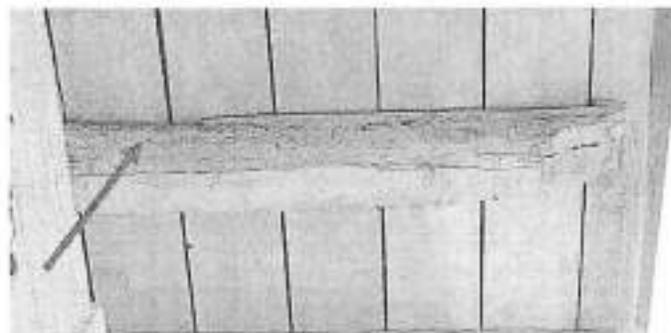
Elementos con pérdida en su sección (Fuente: Autor)
